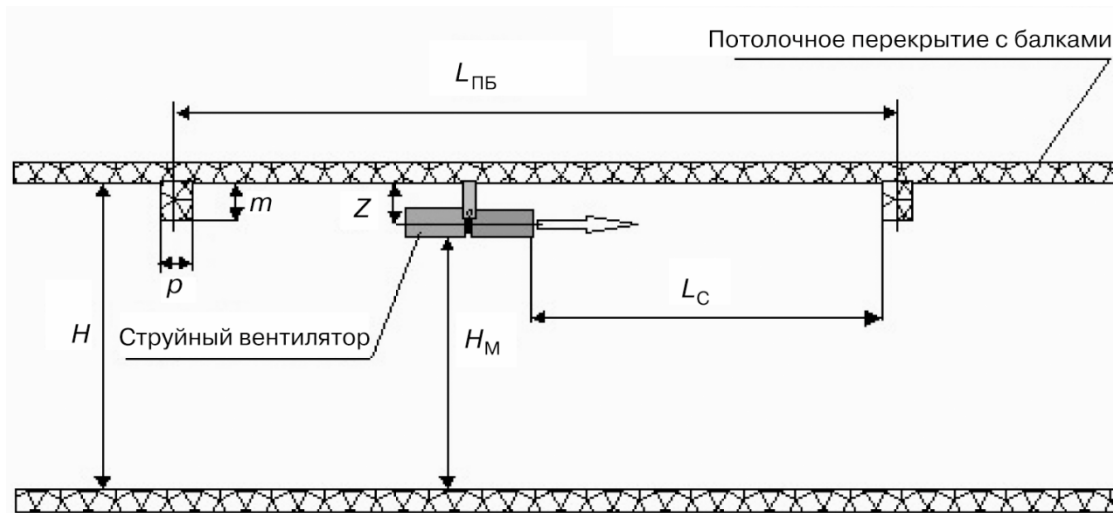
Схема расположения струйного вентилятора под потолочным перекрытием
